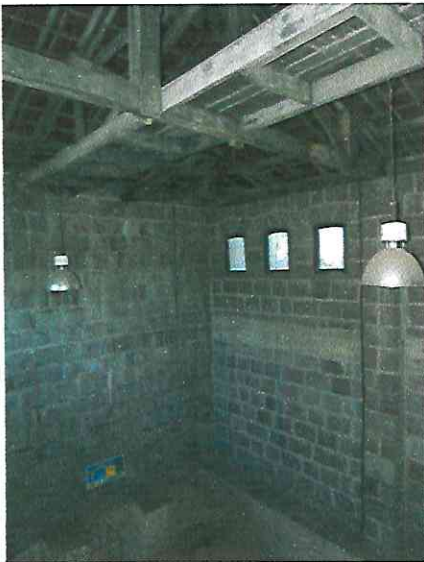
e 22 – Imóvel 4 – Cantina de Vinhos
